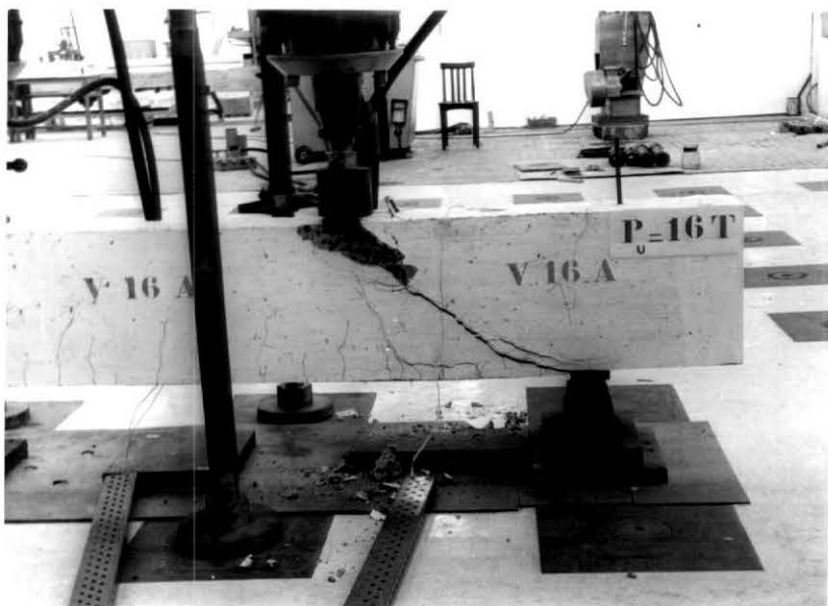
Vista da ruptura da viga 16A ($a/d=1,6$) por esmagamento da biela de concreto.
